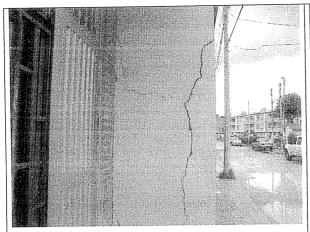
Fisuras verticales en la fachada del inmueble vecino ubicado en la carrera 111 # 140 A – 51.
